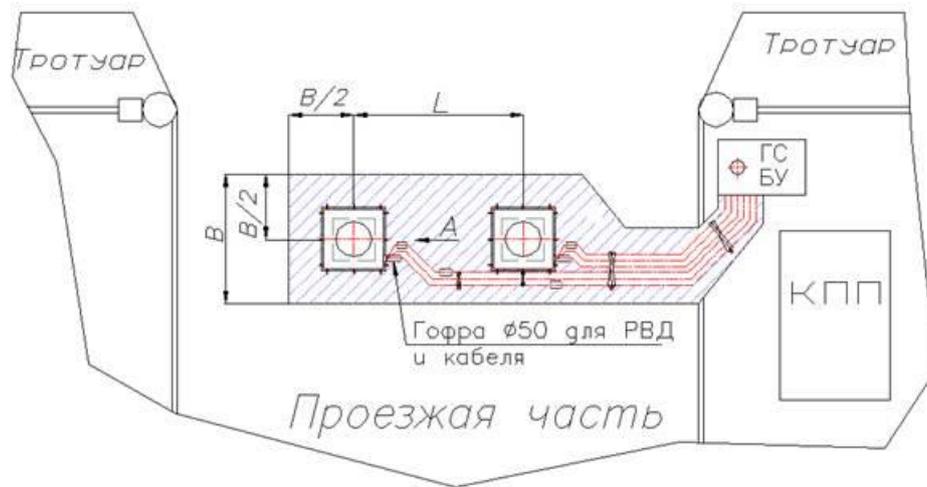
Пример монтажа конструкции с гидравлическим приводом
